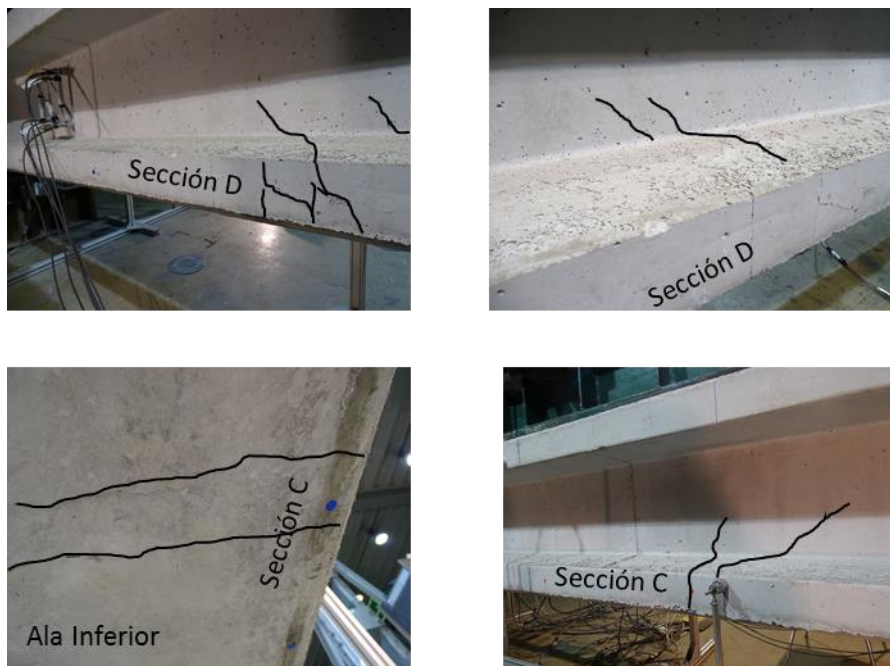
Fisuras en la viga I-3 previas al ensayo a flexión.
